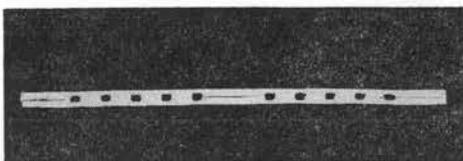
ベーパードレーン用紙断面 (100×3 mm)
